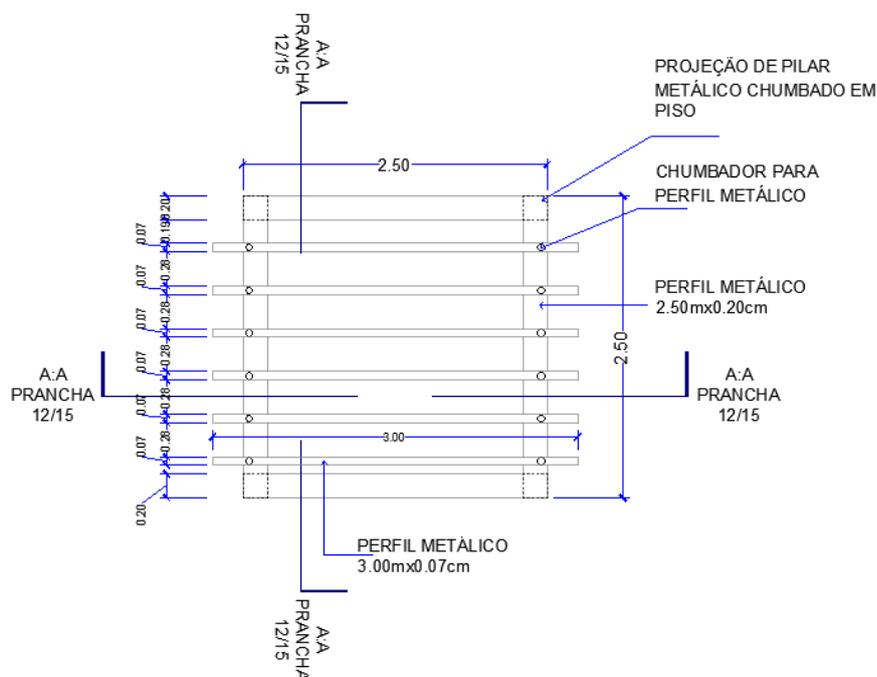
PLANTA BAIXA DO PERGOLADO – ESPECIFICADO EM PROJETO DE ARQUITETURA
